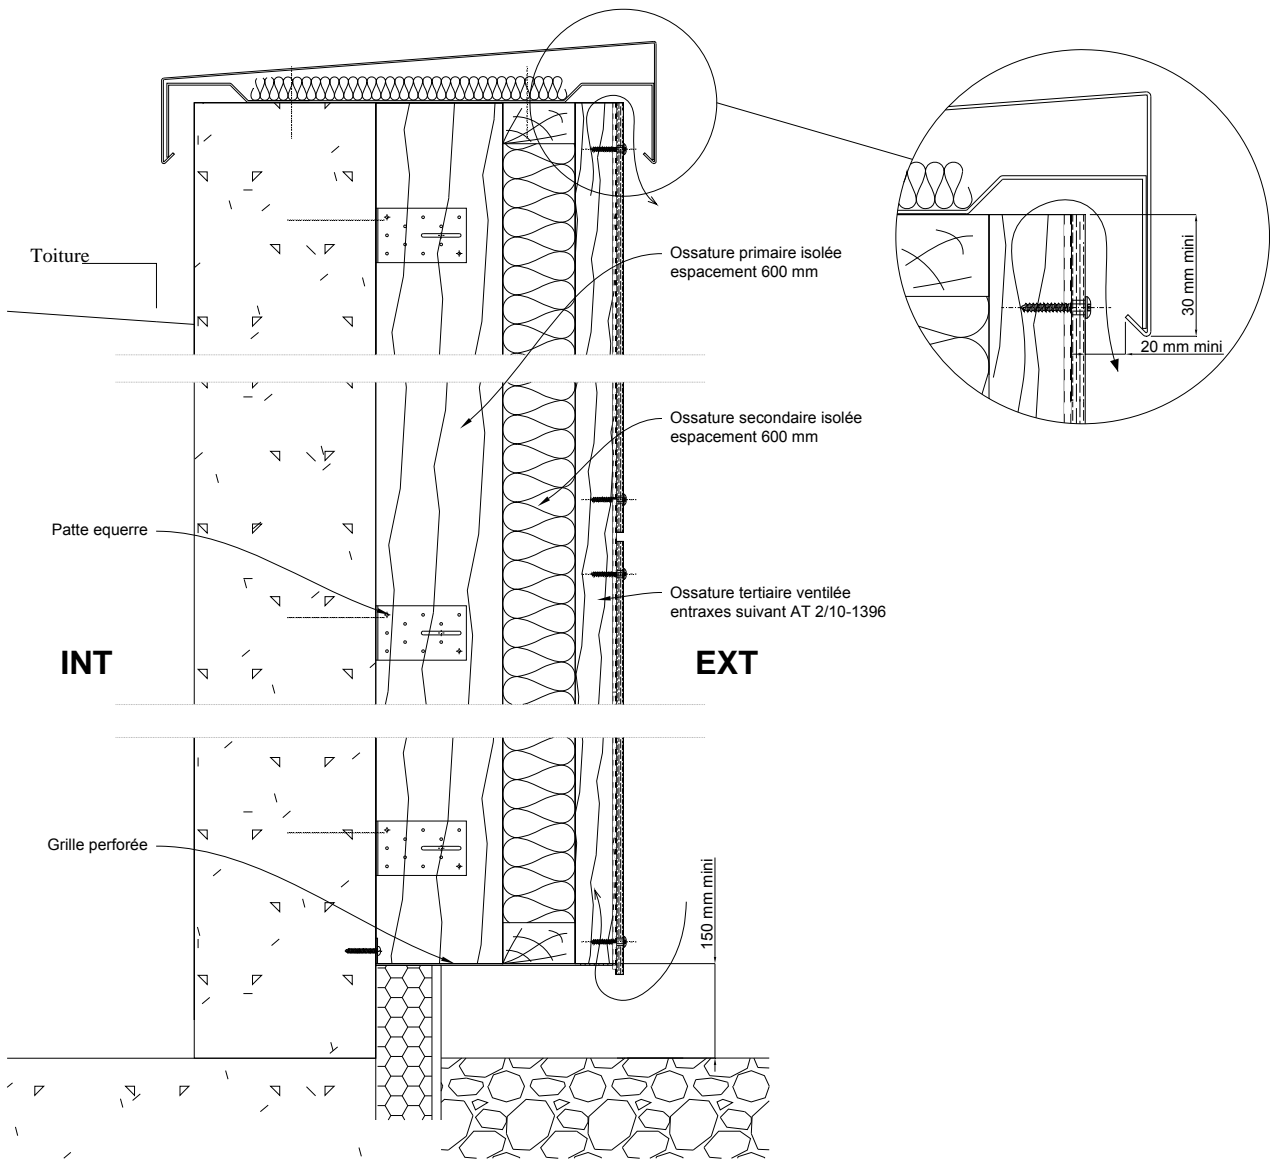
Réseaux croisés sur BA - Coupe verticale générale
